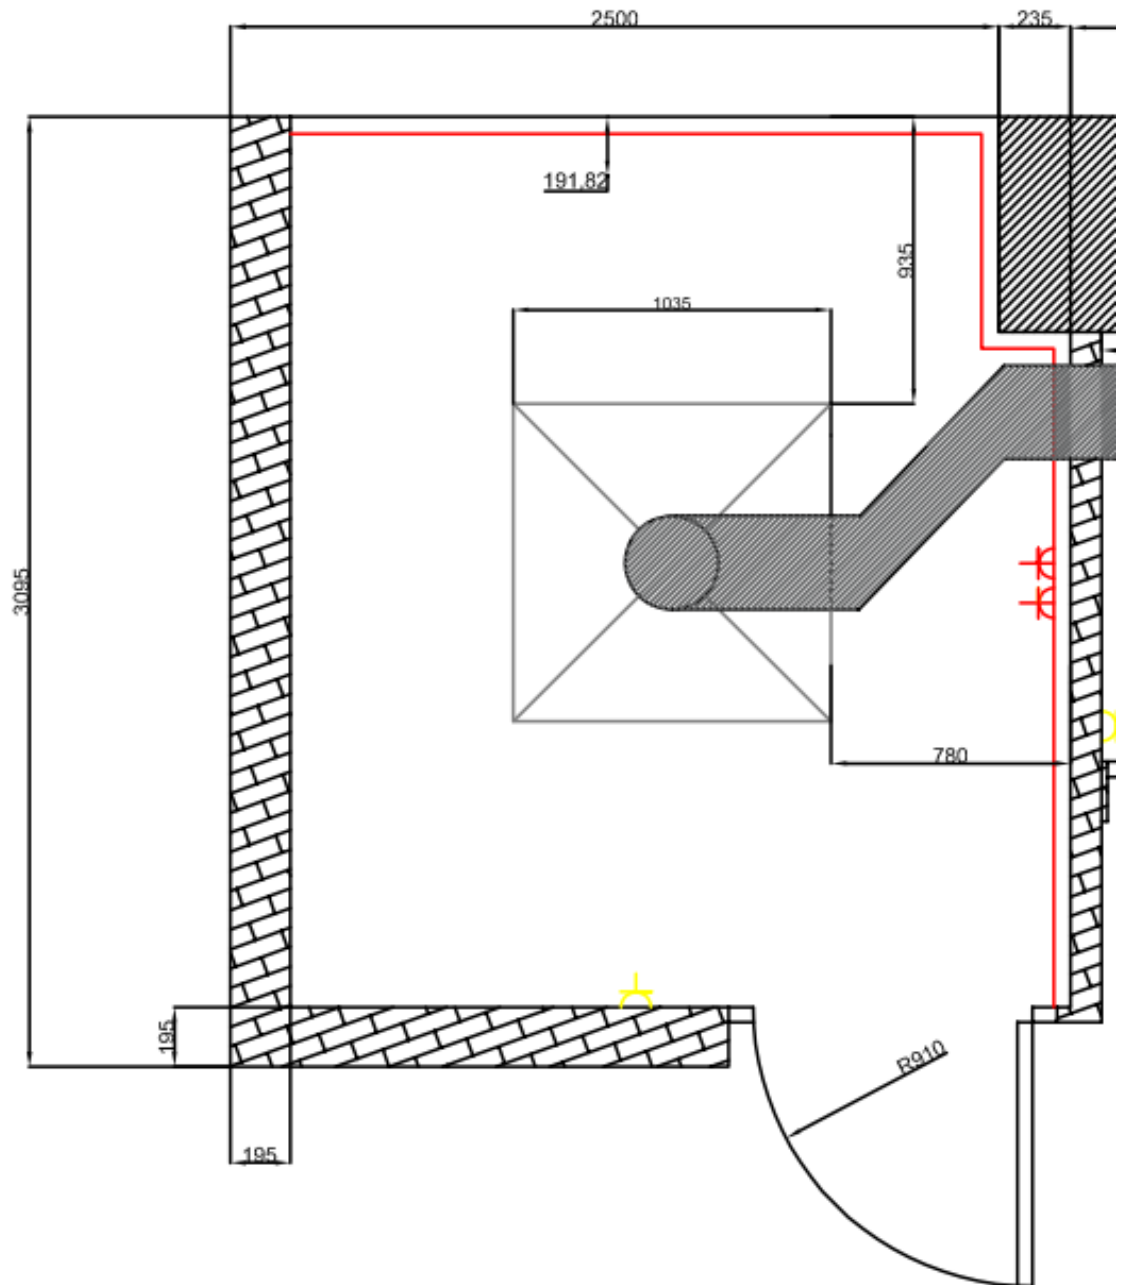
Plano en planta acotado sala 2. Fuente: propia. Realizado en AutoCAD.
